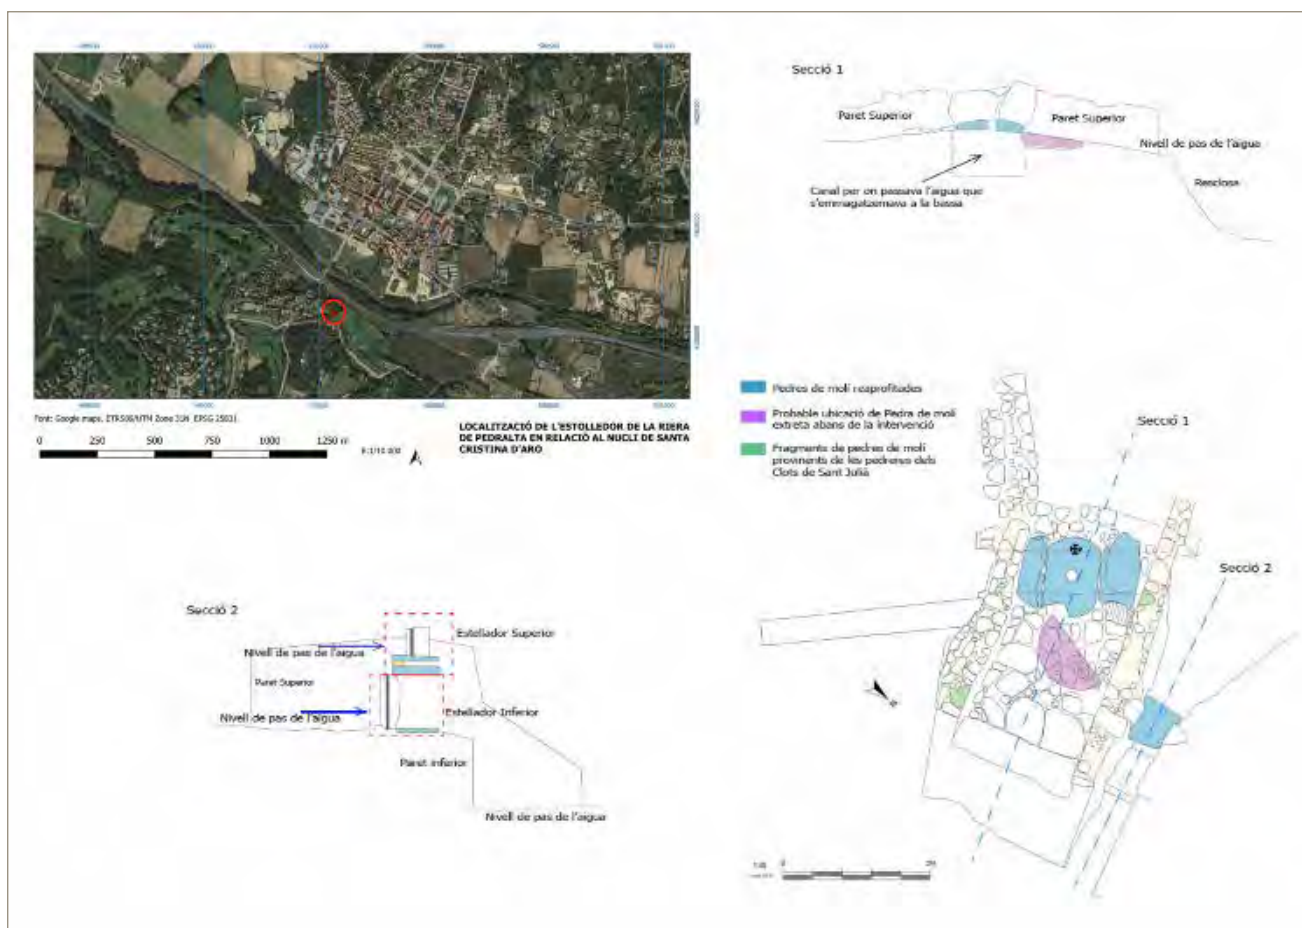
Detall de la localització de l'estollador. Planta i seccions de l'estructura hidràulica.
